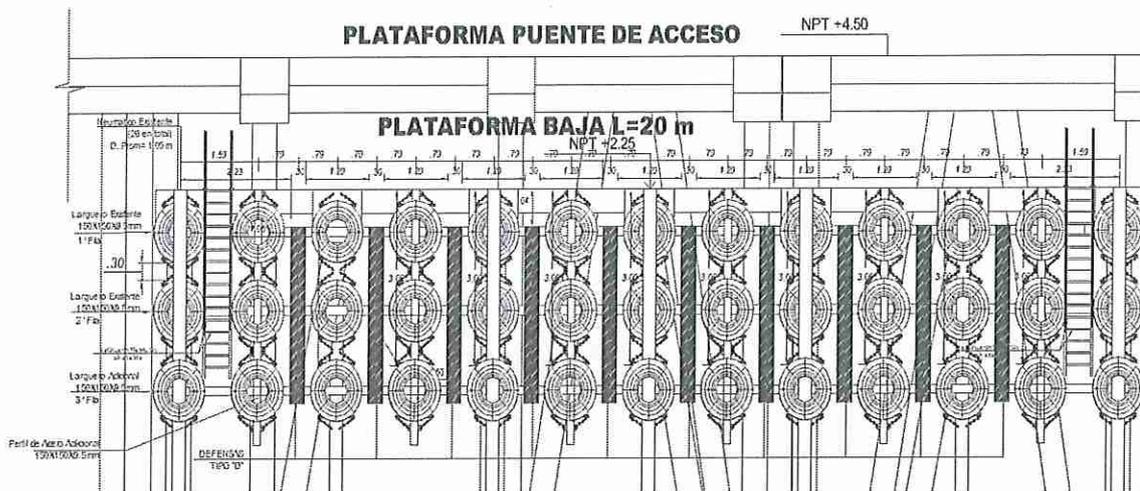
Adición de tercera fila de llantas en la plataforma baja.
